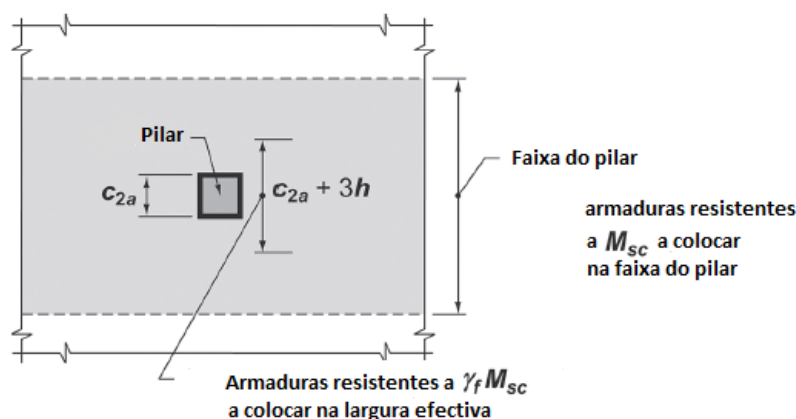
Localização da armadura de flexão na laje (Adaptado de ACI 318-14, 2014)
